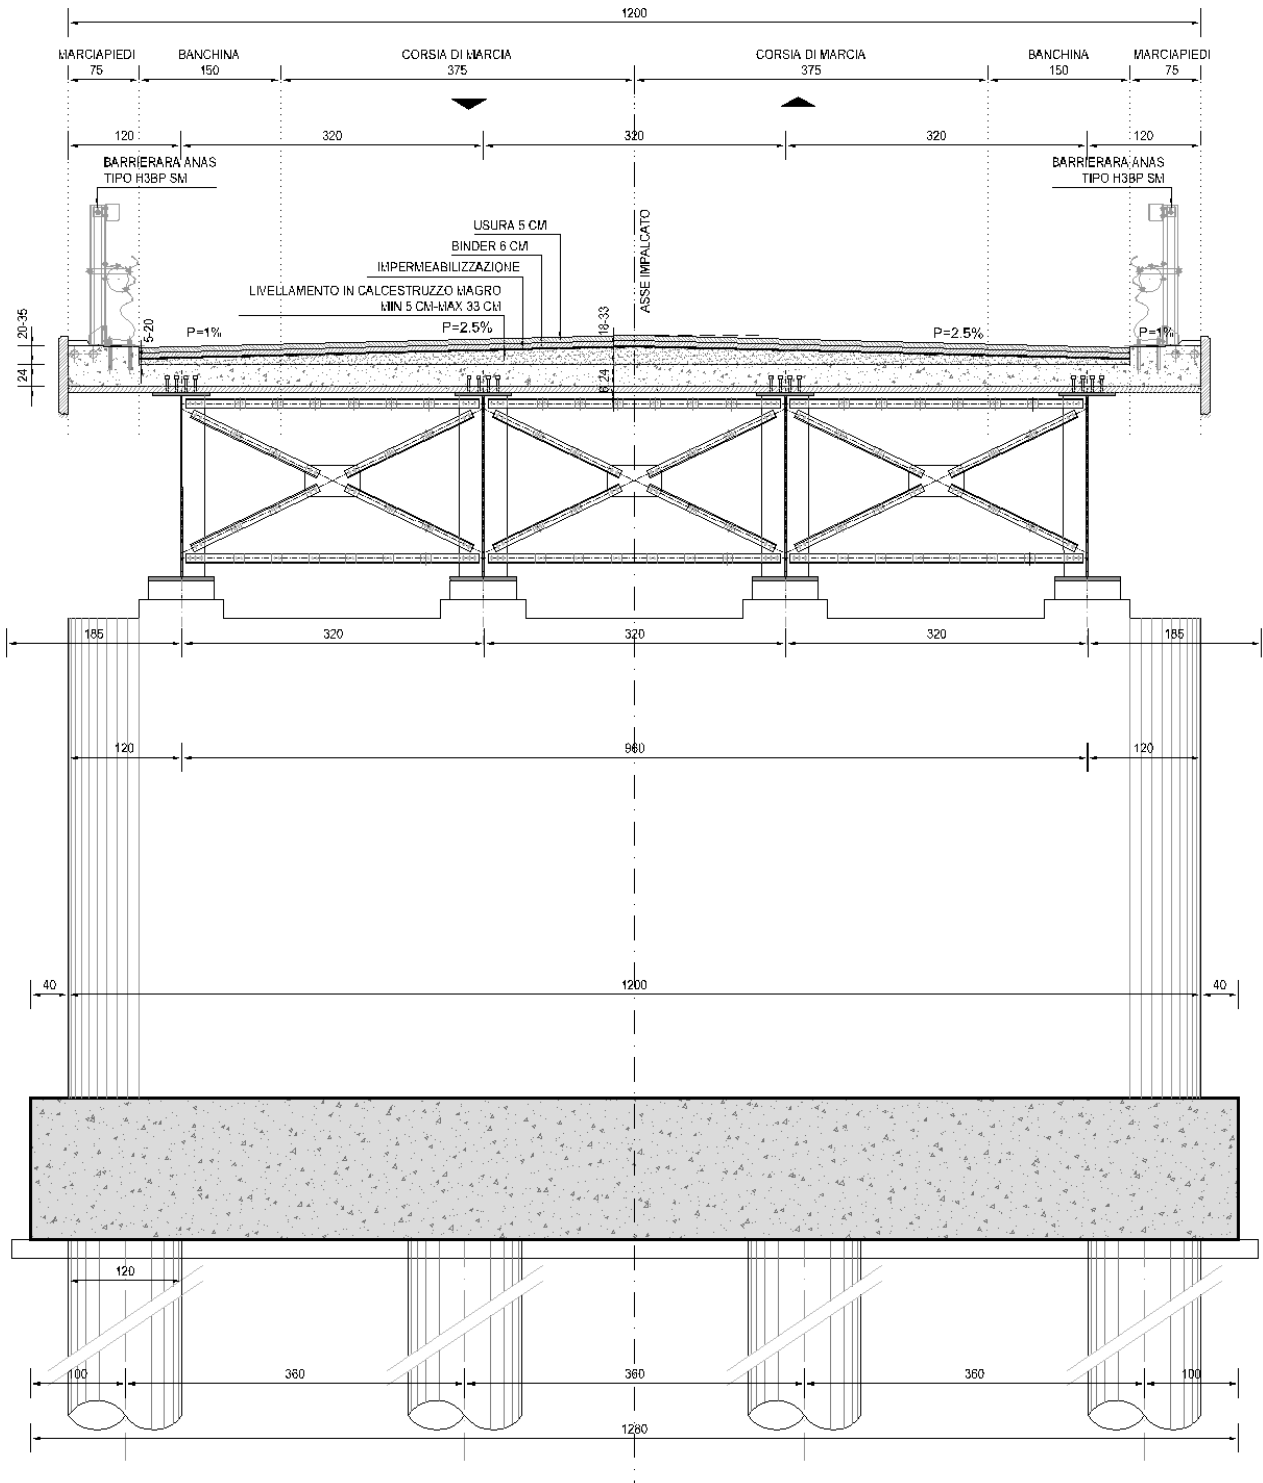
SEZIONE IMPALCATO (SU PILA)
